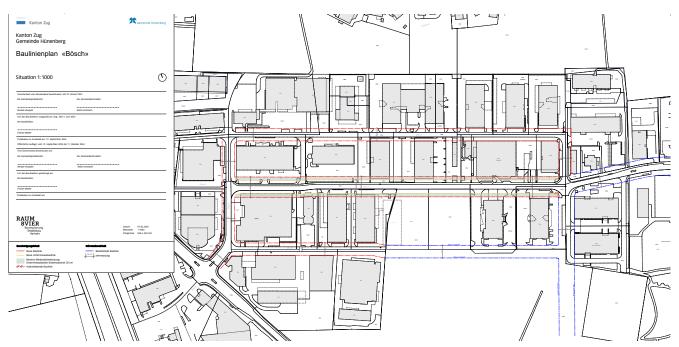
verkleinerte Ansicht des Baulinienplans Bösch (ohne Massstab)
